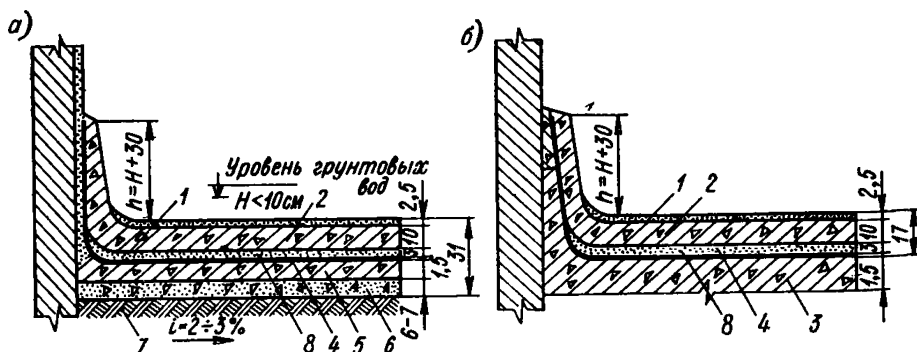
Конструкция гидроизоляции из рулонных материалов при уровне грунтовых вод до 50 см
